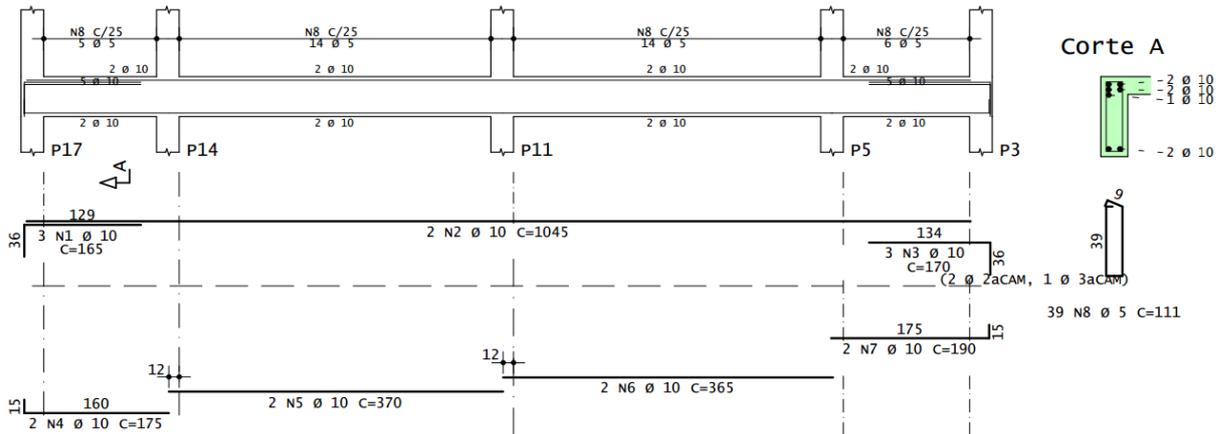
Armadura da viga V1 – coberta (nível +6,00)
